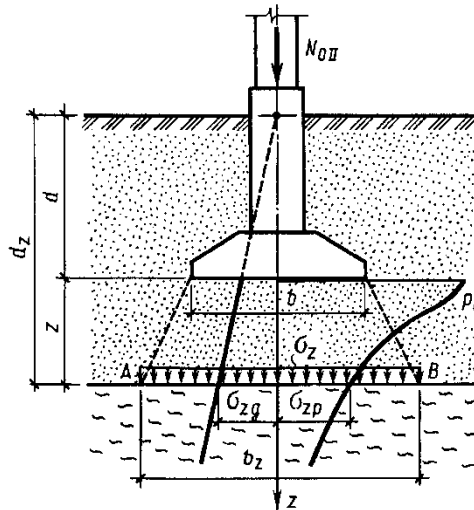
Расчетная схема к проверке давления на подстилающий слой слабого грунта.
